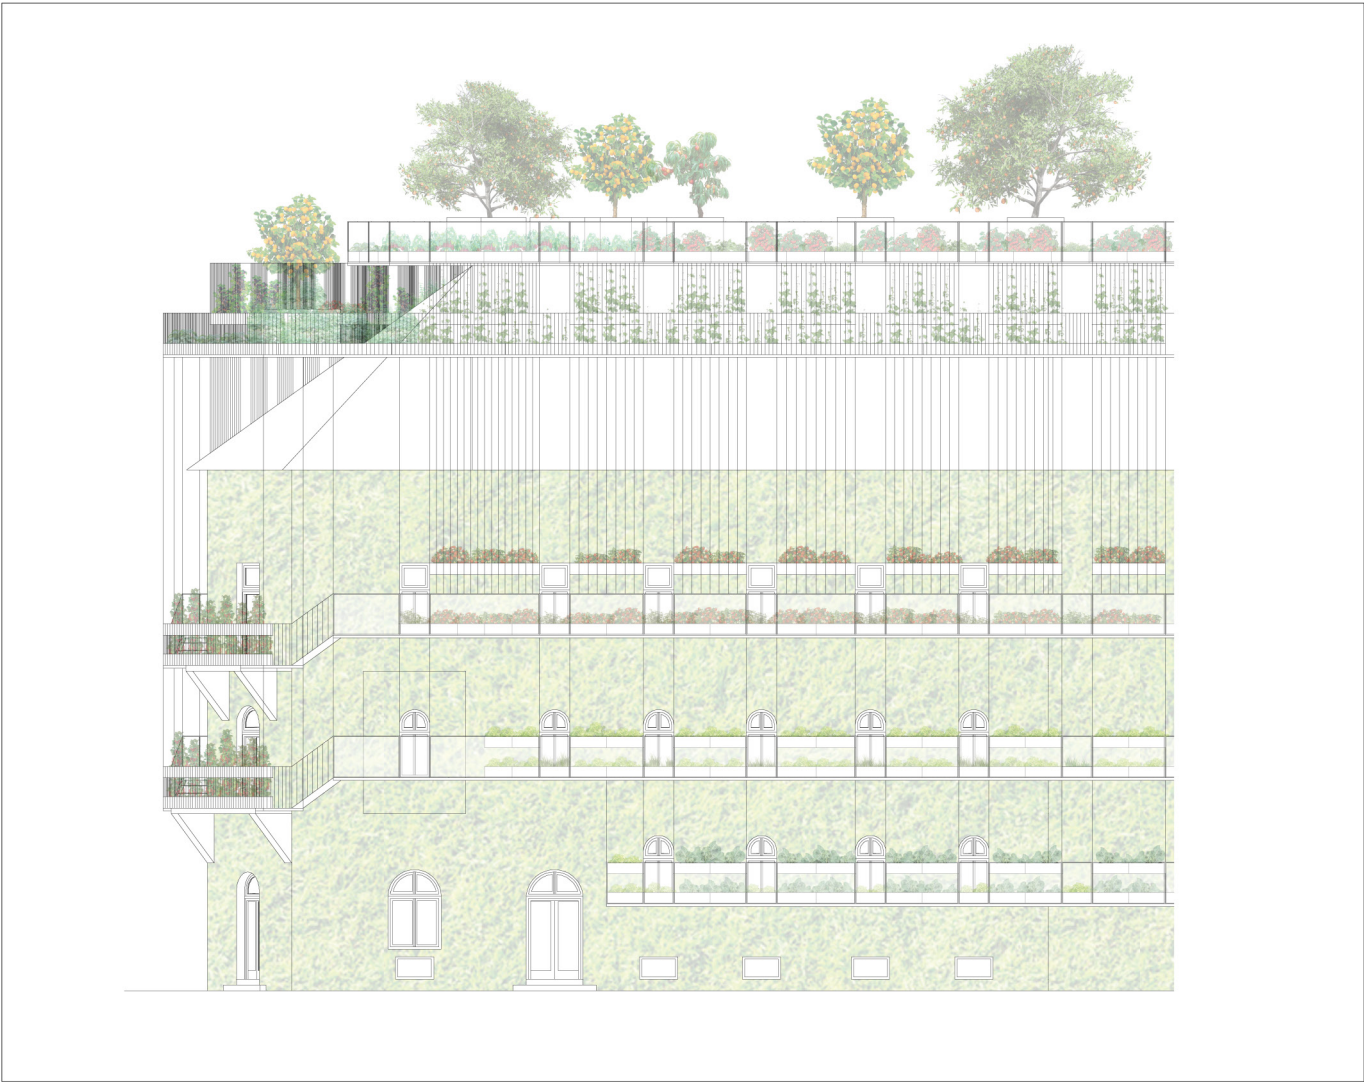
BESTAND Wohngebäude Merangasse / Nibelungengasse
